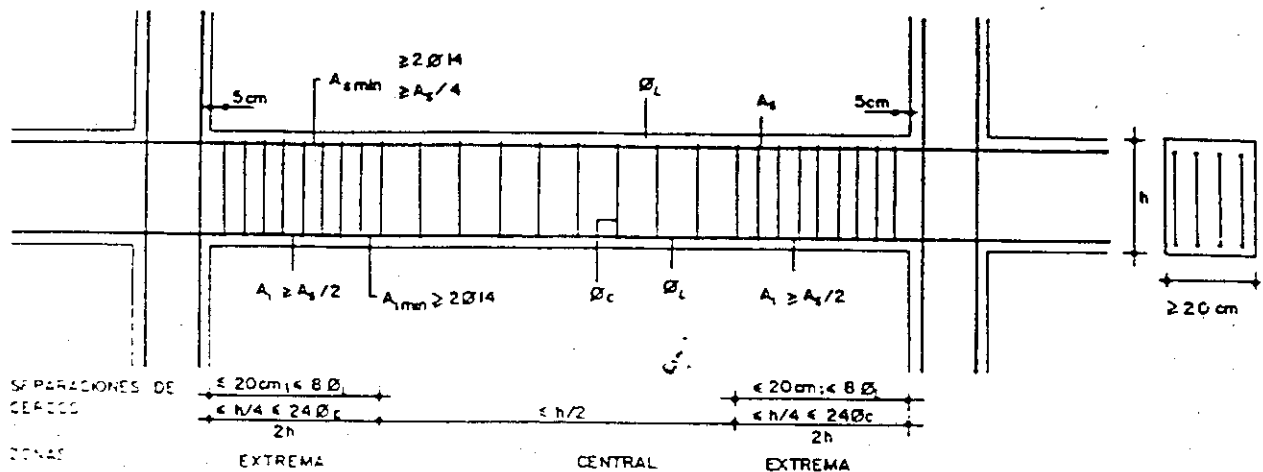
Viga de hormigón armado de ductilidad alta. Armaduras mínimas.
